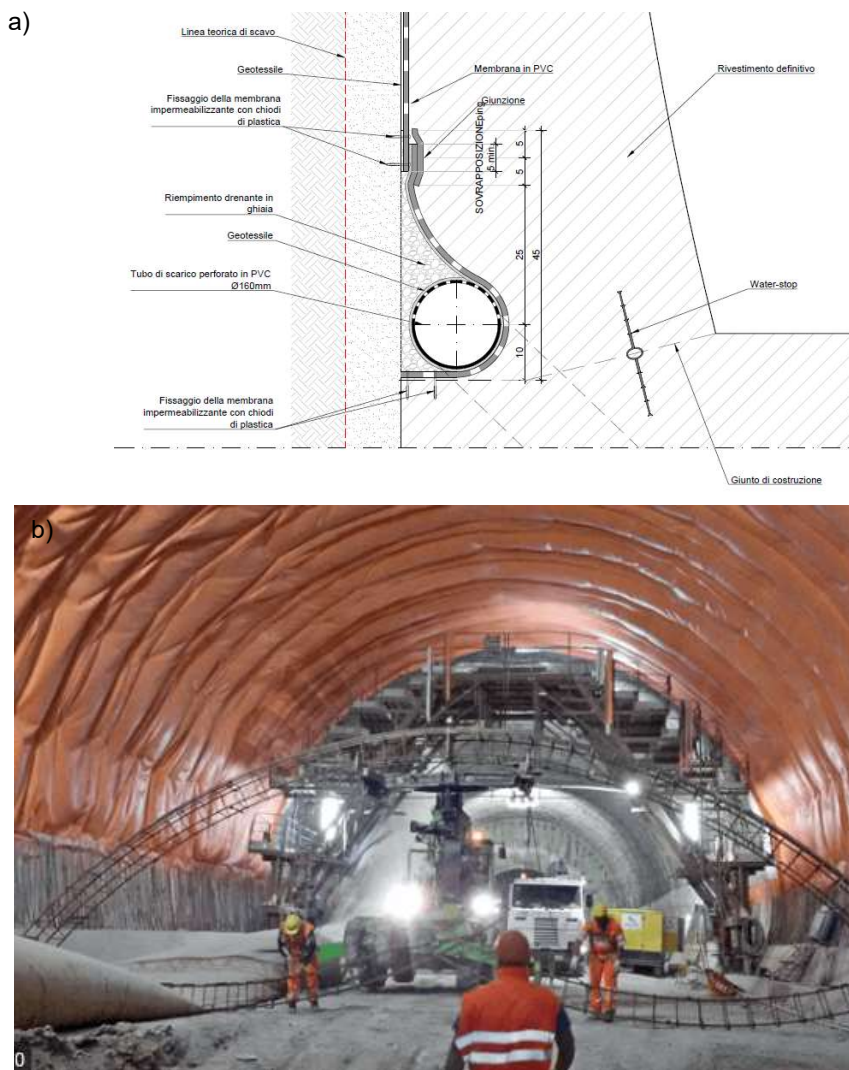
a) Dettaglio del tubo di drenaggio per la raccolta delle acque dell'ammasso roccioso; b) esempio di impermeabilizzazione con membrana in PCV per una galleria naturale.
